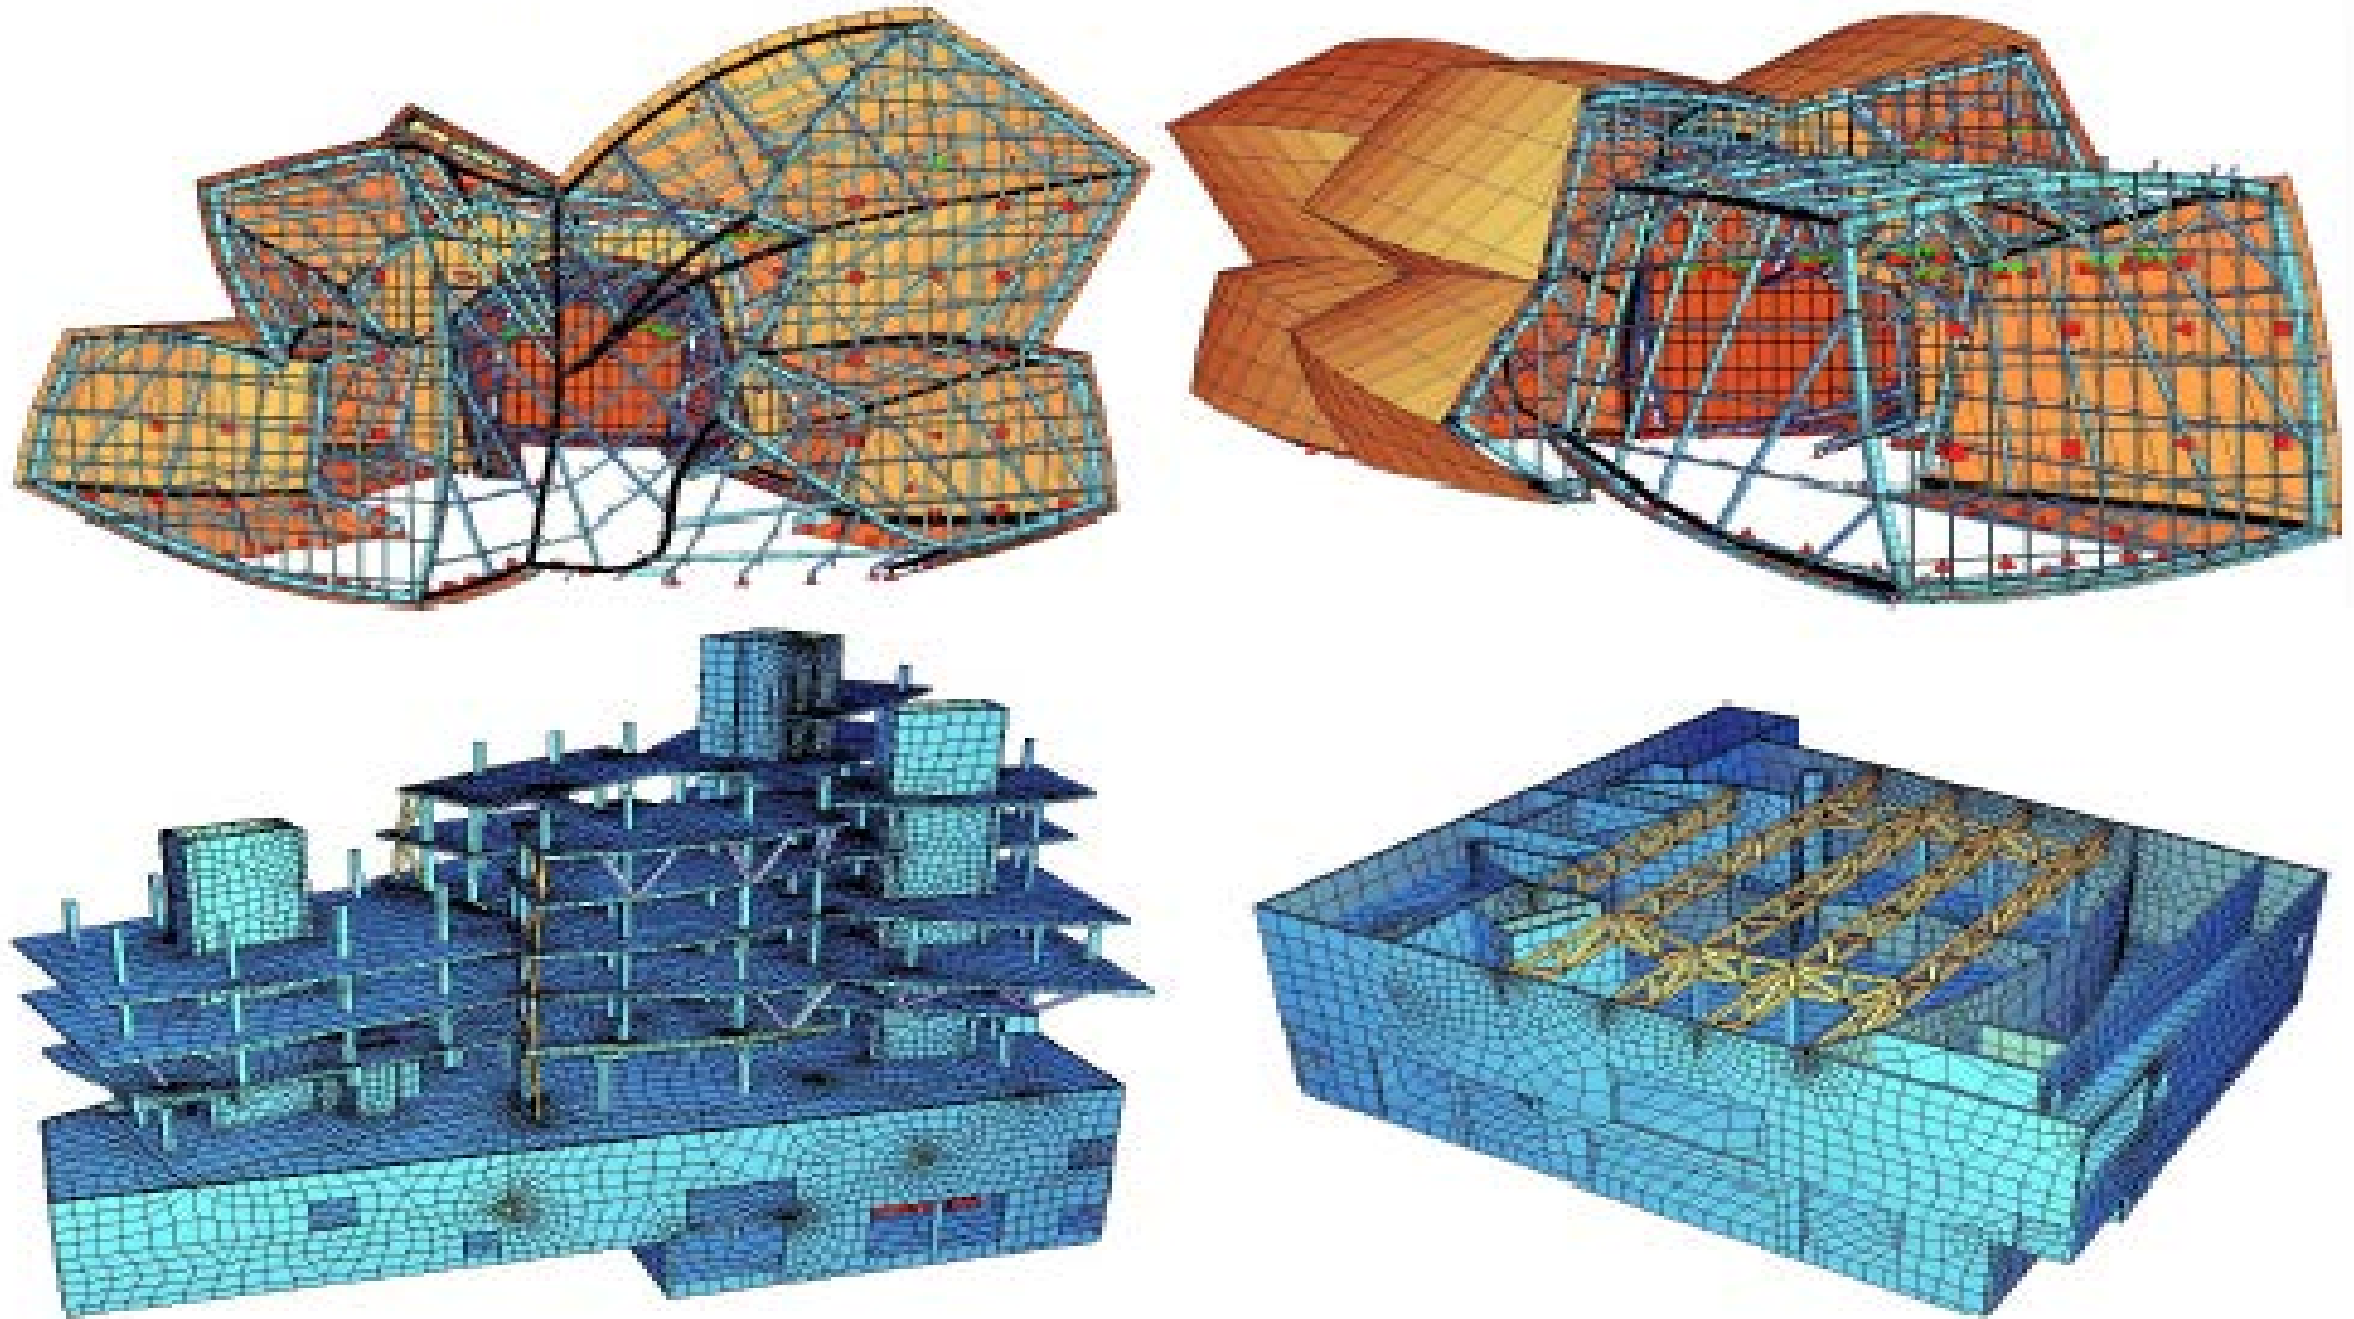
FE-Modelle für Stahlstruktur (1 Modell, oben) und Betonstruktur (2 Modelle, unten)
